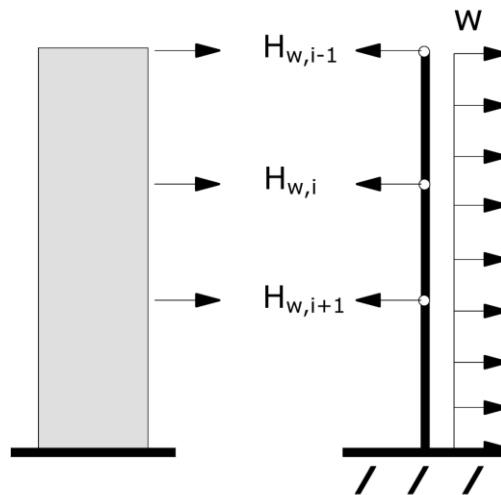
Lastweiterleitung der Horizontalkräfte auf die aussteifende Wandscheibe
